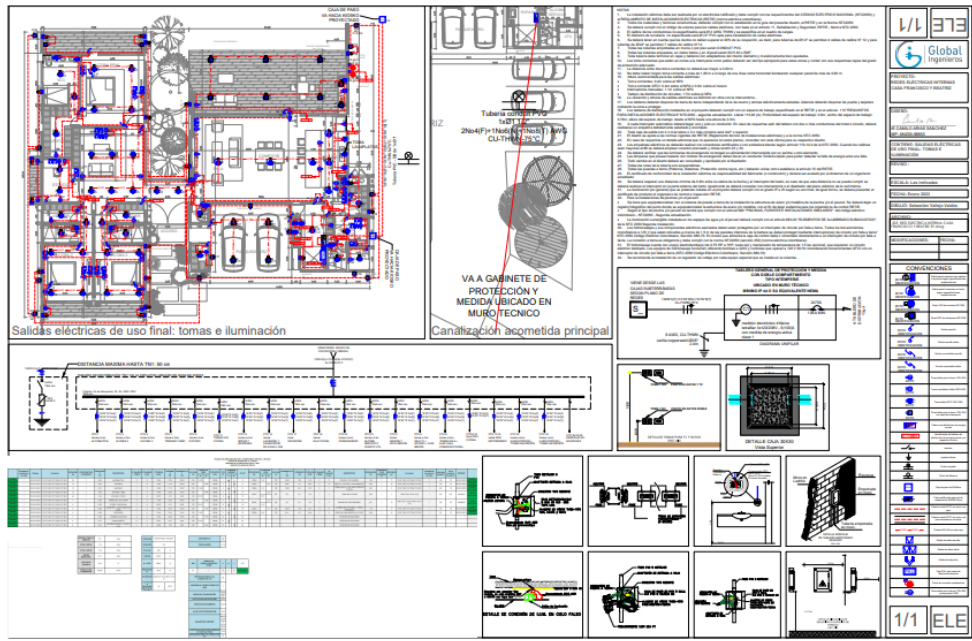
Plano eléctrico salidas eléctricas de uso final vivienda.
